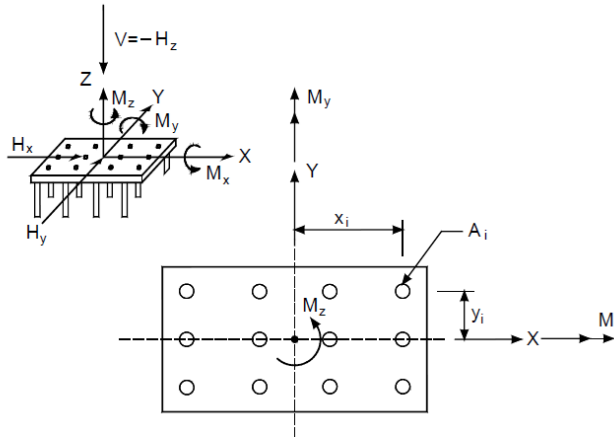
Distribución de esfuerzos en la hipótesis de encepado rígido y pilotes articulados en cabeza²⁷
